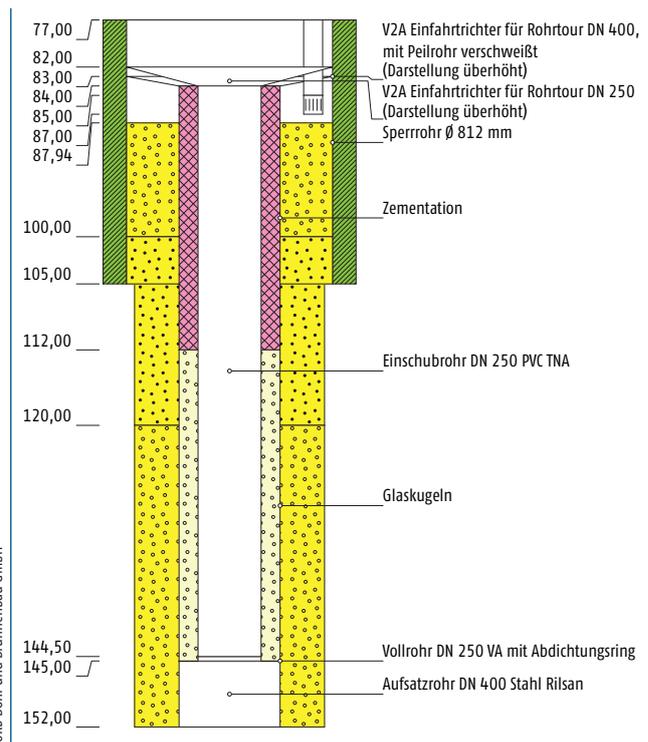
Detailzeichnung Trichterkonstruktionen
